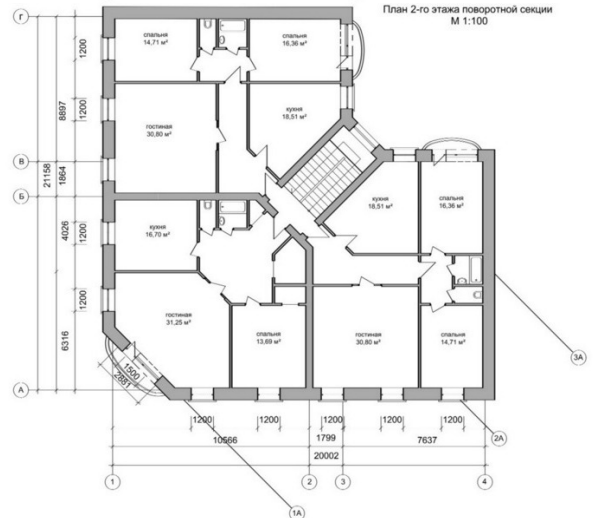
Приклад об'ємно-планувального рішення житлового будинку
